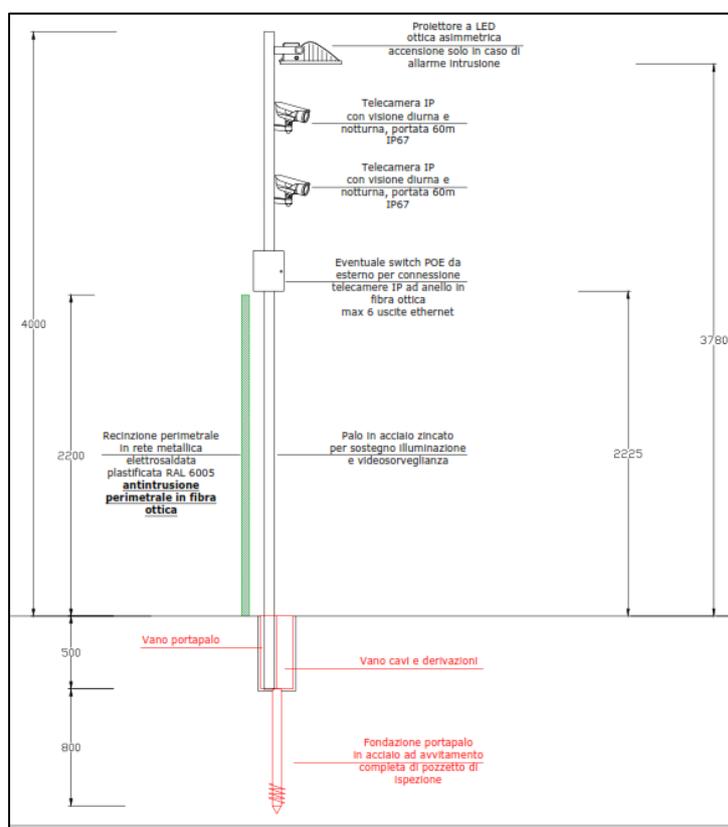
Particolare dei pali previsti per illuminazione e videosorveglianza con fondazione a vite.
